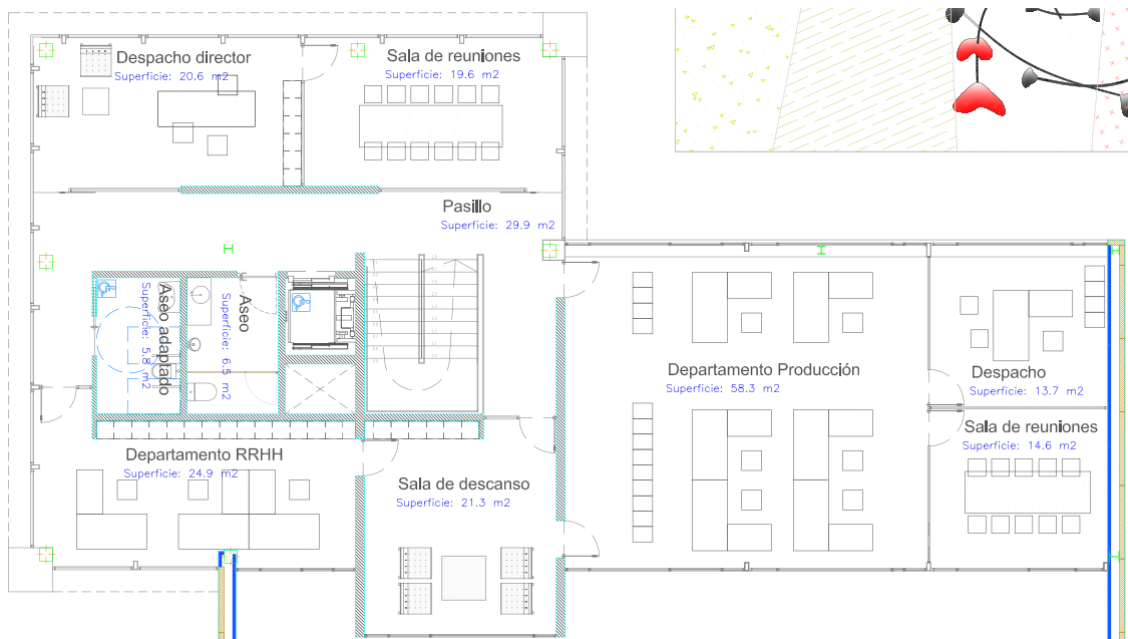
Distribución planta primera Nave de Fabricación y Oficinas [Elaboración propia]
